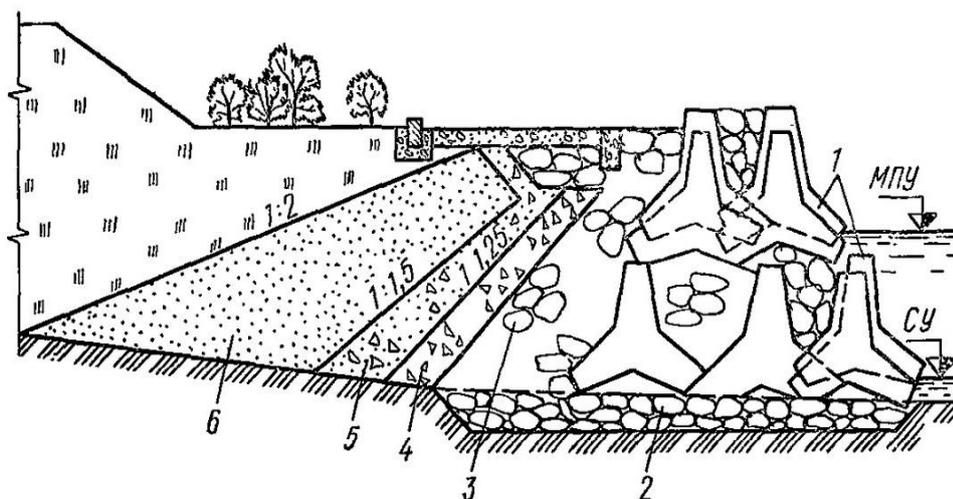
Конструкция берегового укрепления опоясок из бетонных блоков.
